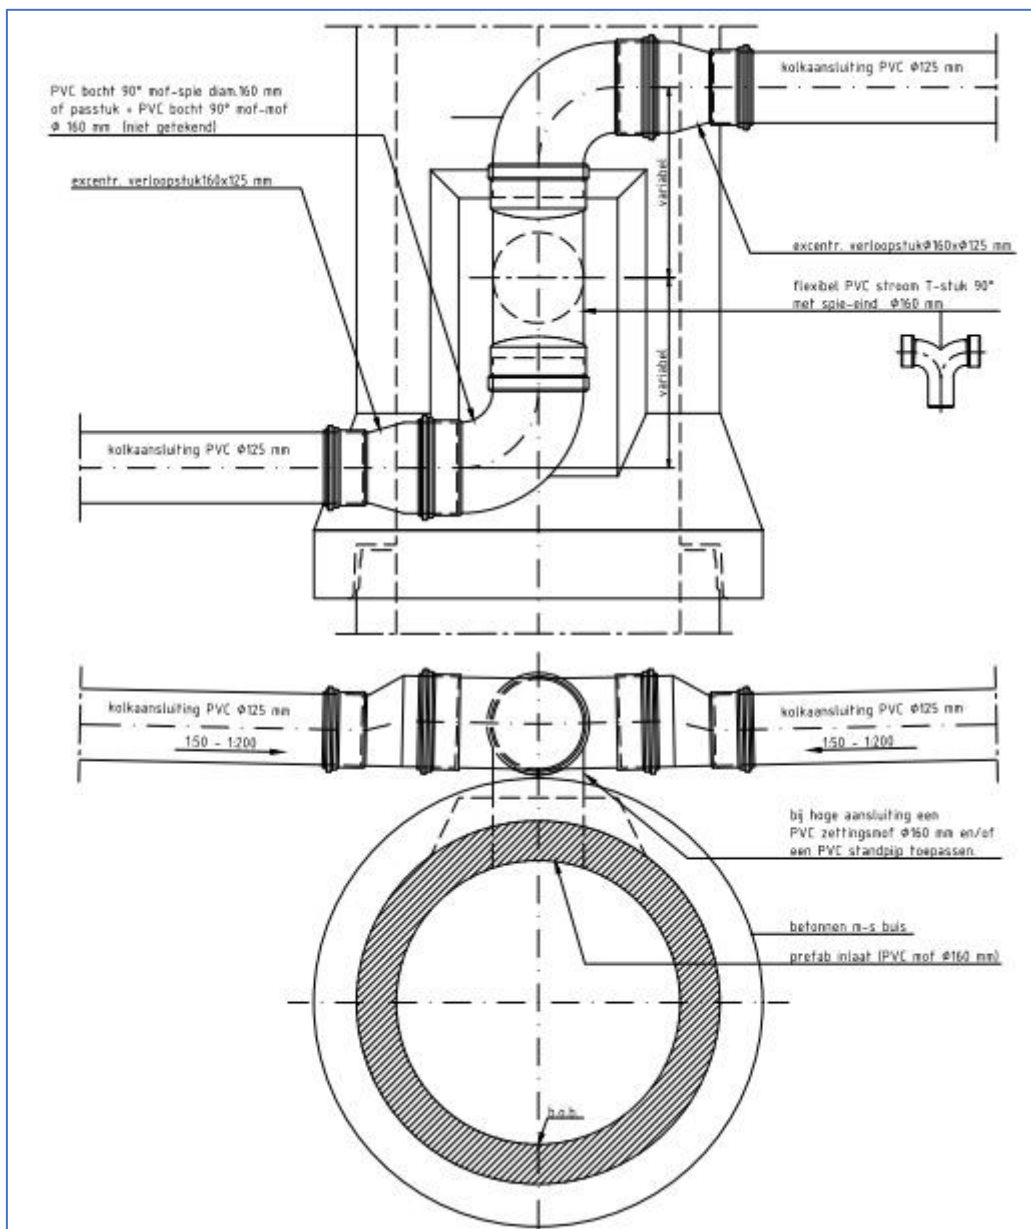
Detail riool bovenaansluiting op betonnen riool, erfgrans op tuin
